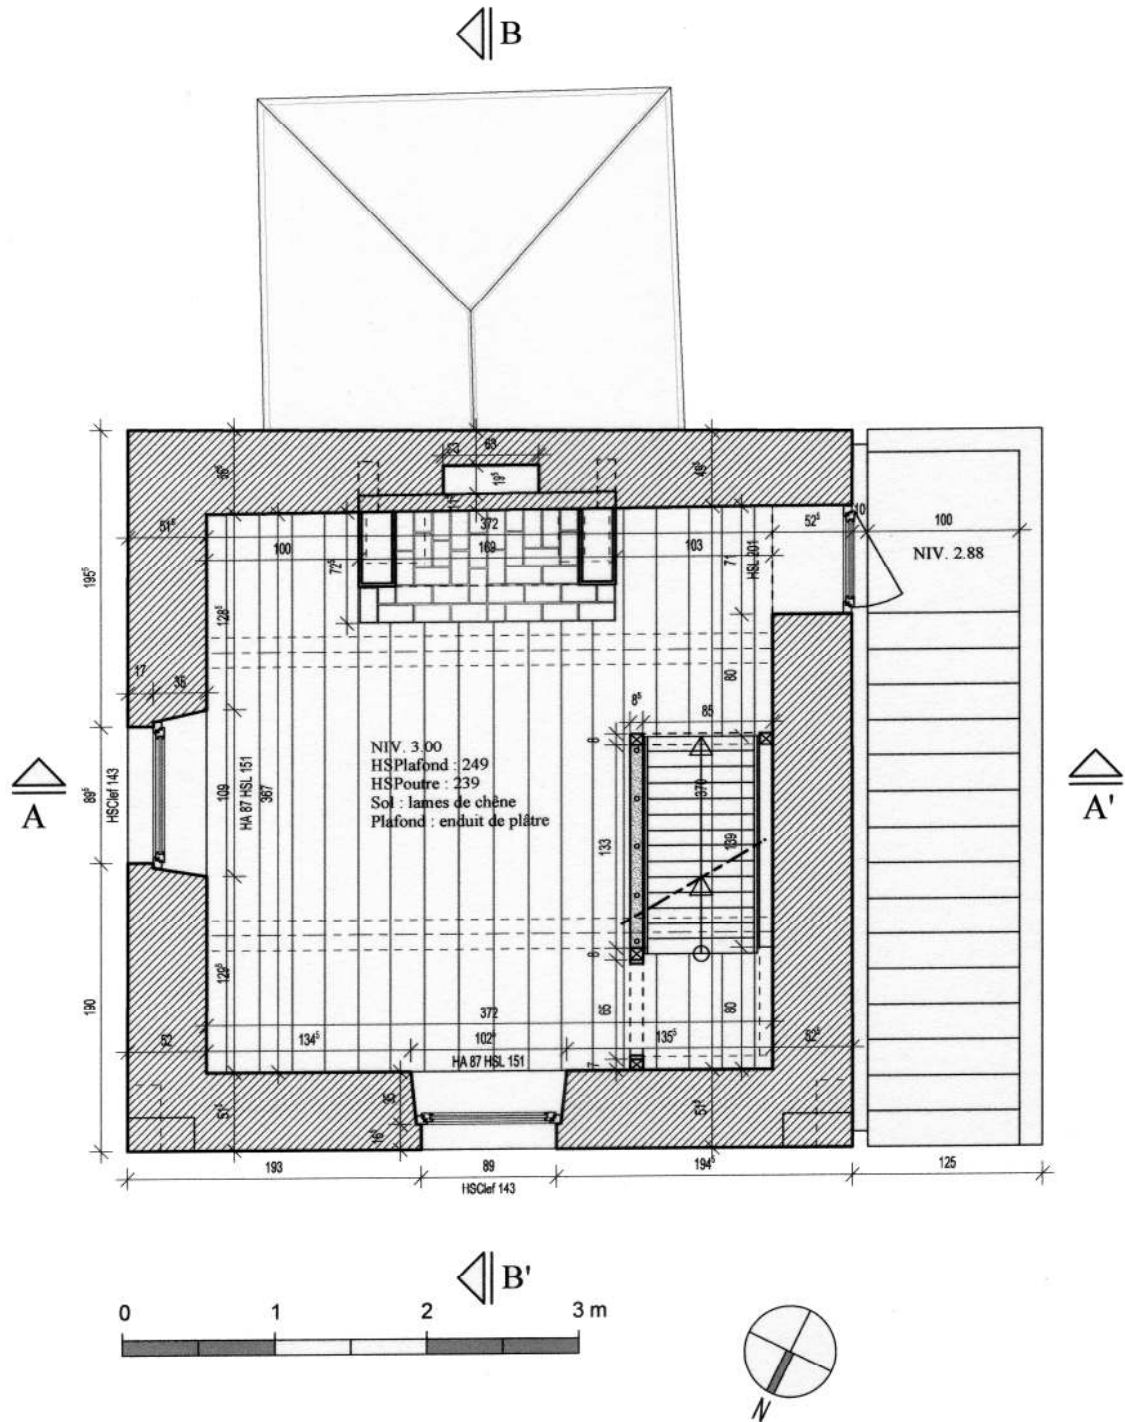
Pavillon. Vue en plan 1^{er} étage. Ech. 1/50^e. Situation projetée. IG 2008.
